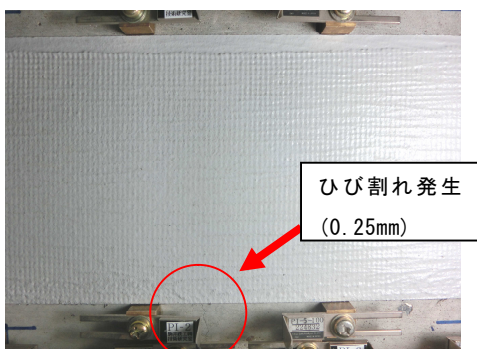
AZX1 ひび割れ発生時 (下面)
